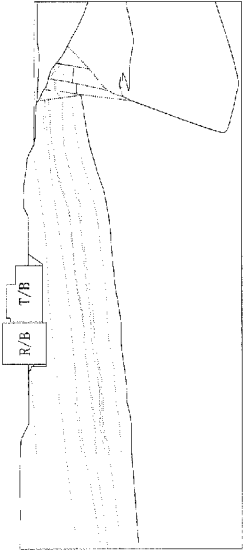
(2) 解析用要素分割図 (Y-Y' 断面)
